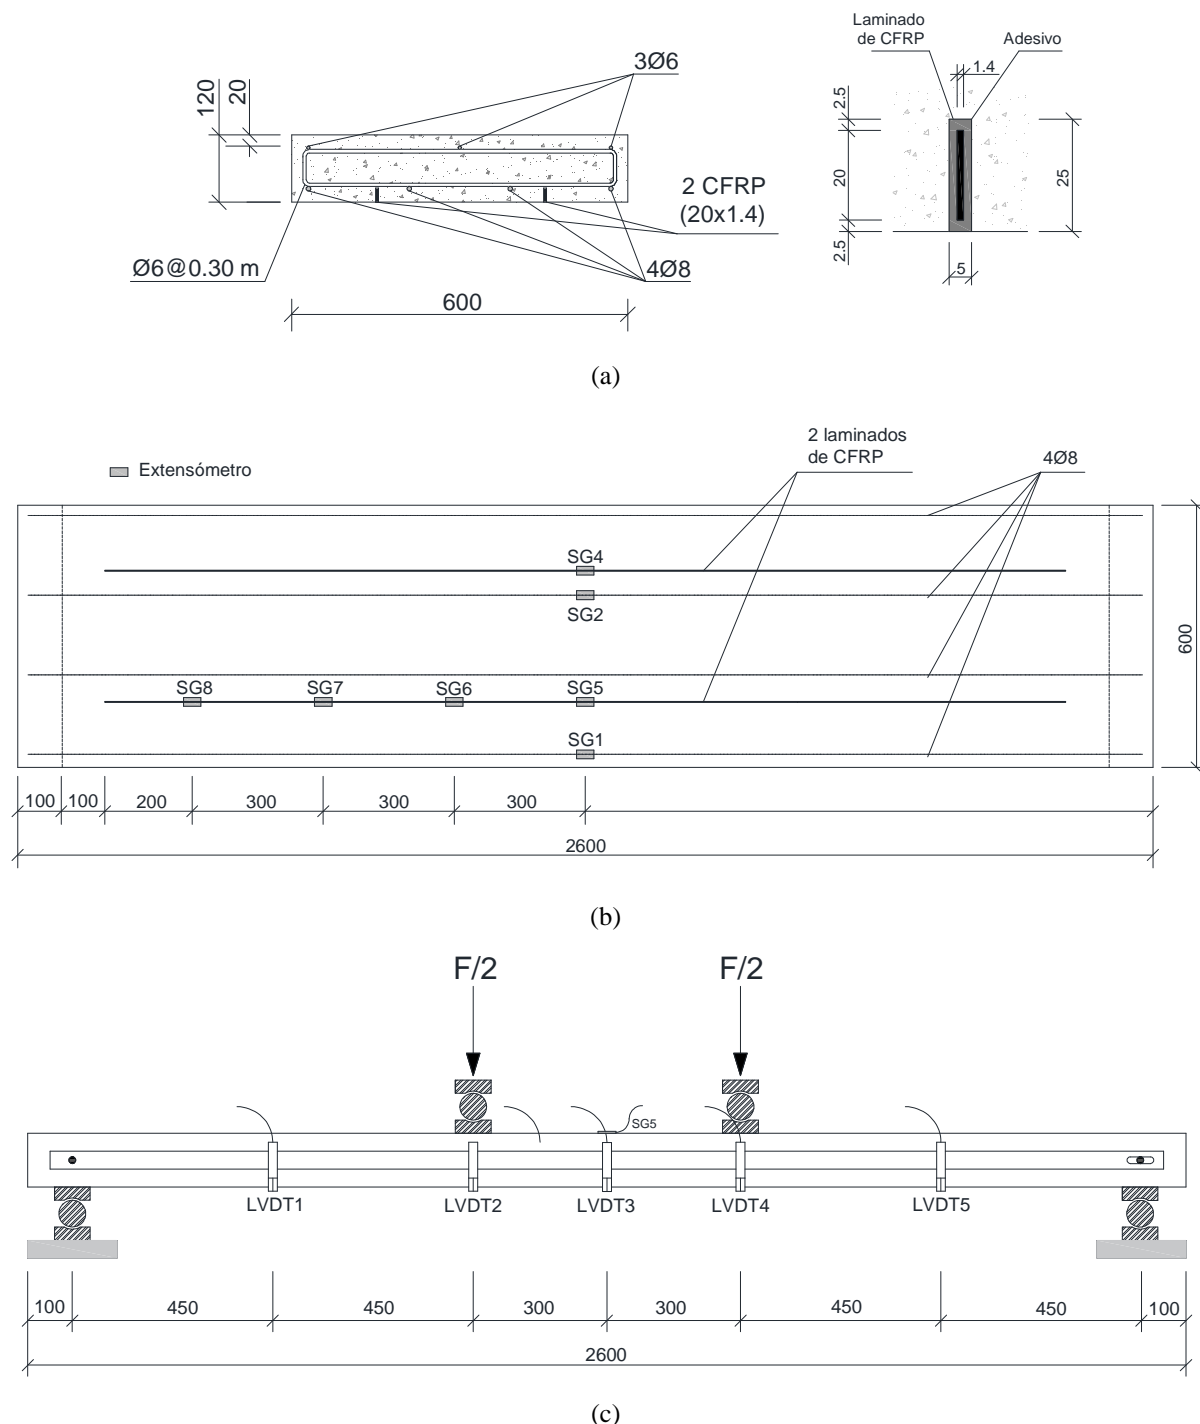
Faixas de laje: (a) geometria da secção transversal; (b) geometria longitudinal e posição dos extensómetros; (c) configuração do ensaio. Nota: todas as dimensões estão em milímetros.
